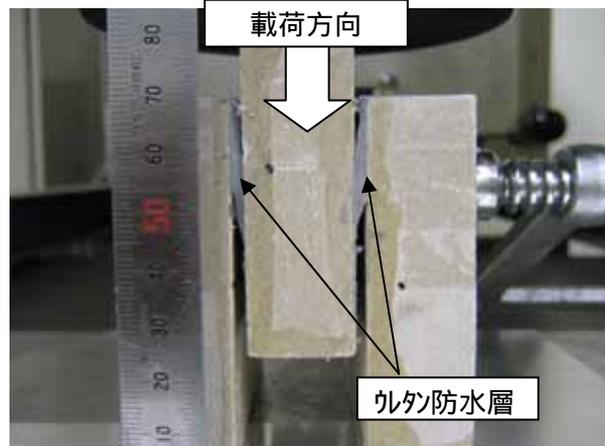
ウレタン防水材のせん断破壊状況 (ケイ酸カルシウム板の例)
